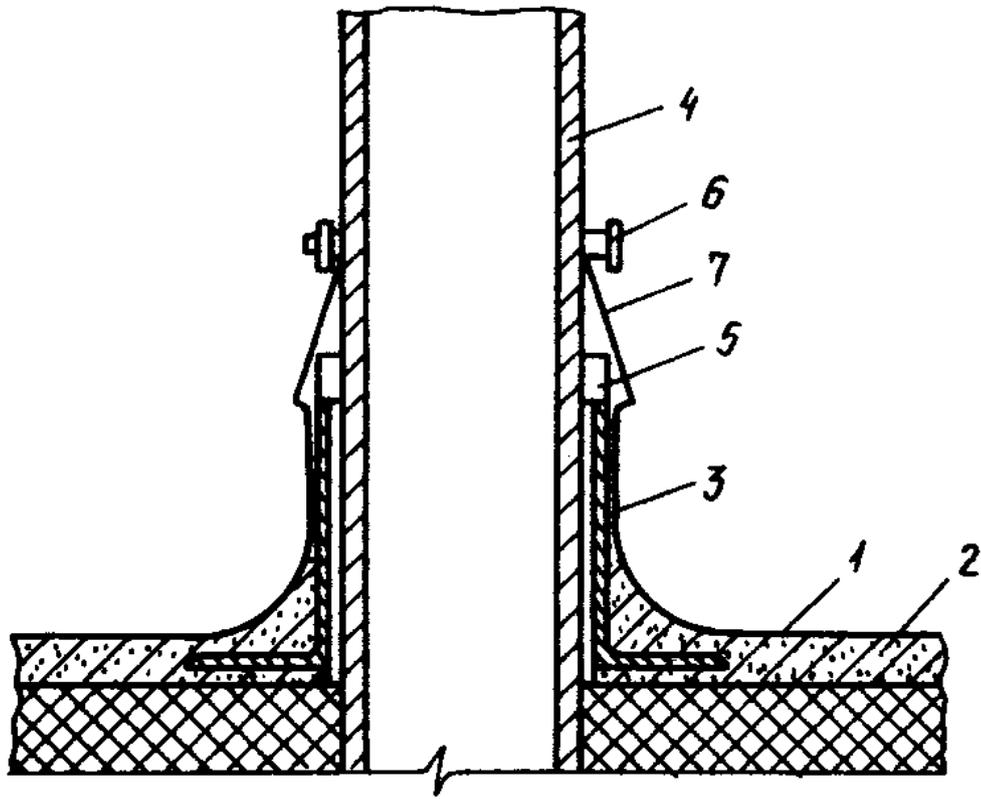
Примыкание безрулонной кровли из мастики ХСПЭ к круглым трубам, проходящим через покрытие
